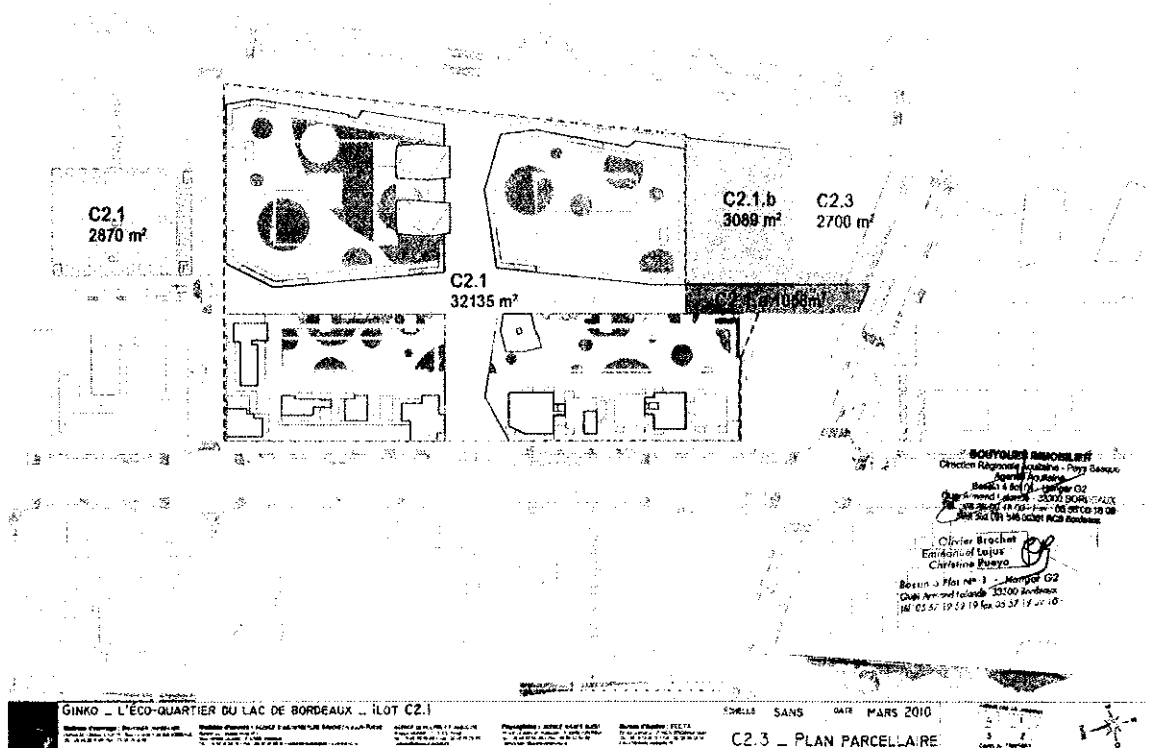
Plan du centre commercial et de l'ilot C2.1 de la ZAC des Berges du Lac de Bordeaux
